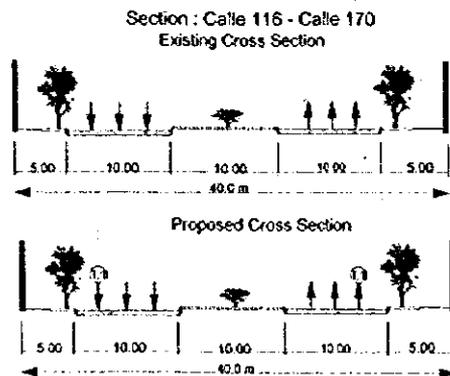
Sección Típica sobre la Avenida 7a (3)
